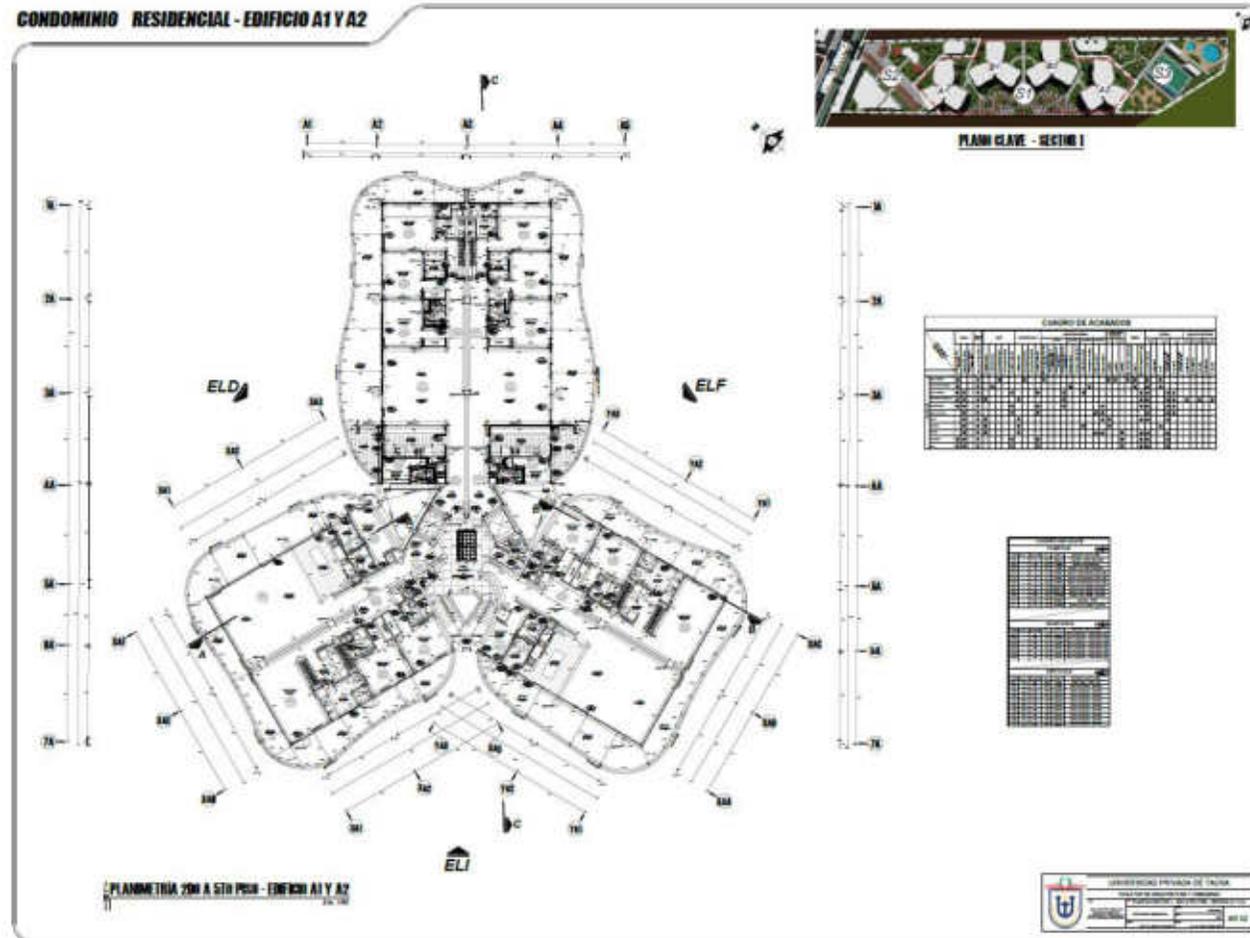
Planimetría 2do a 5to Piso – Edificio A1 y A2 – Sector 1
